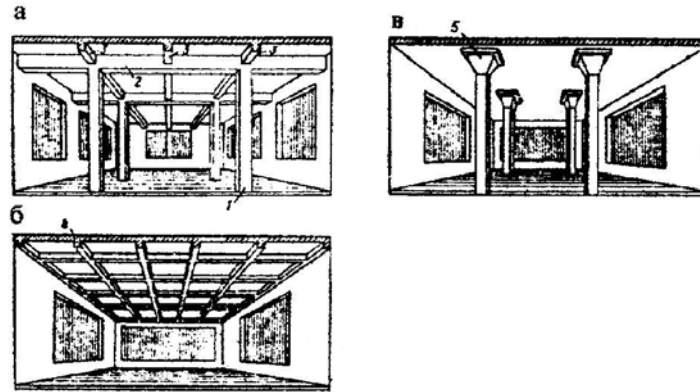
Міжповерхові перекриття громадських будівель:
